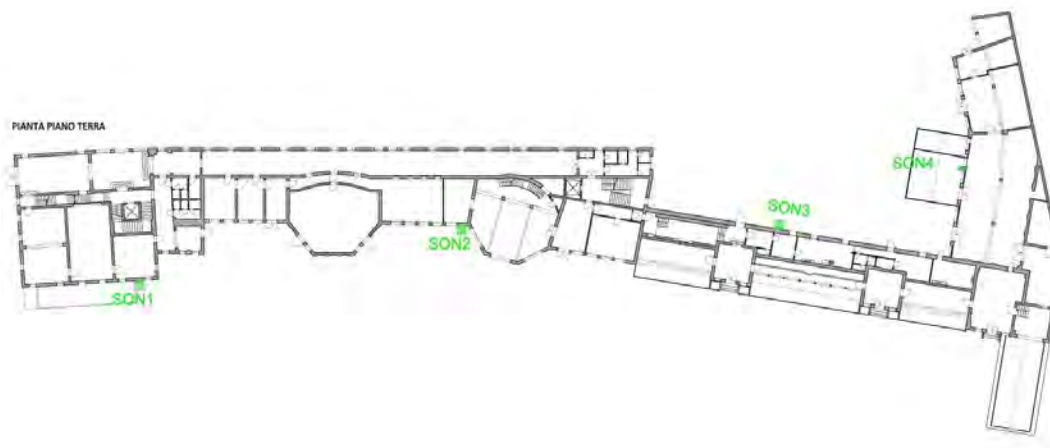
18 - Pianta del complesso – localizzazione campi prova
